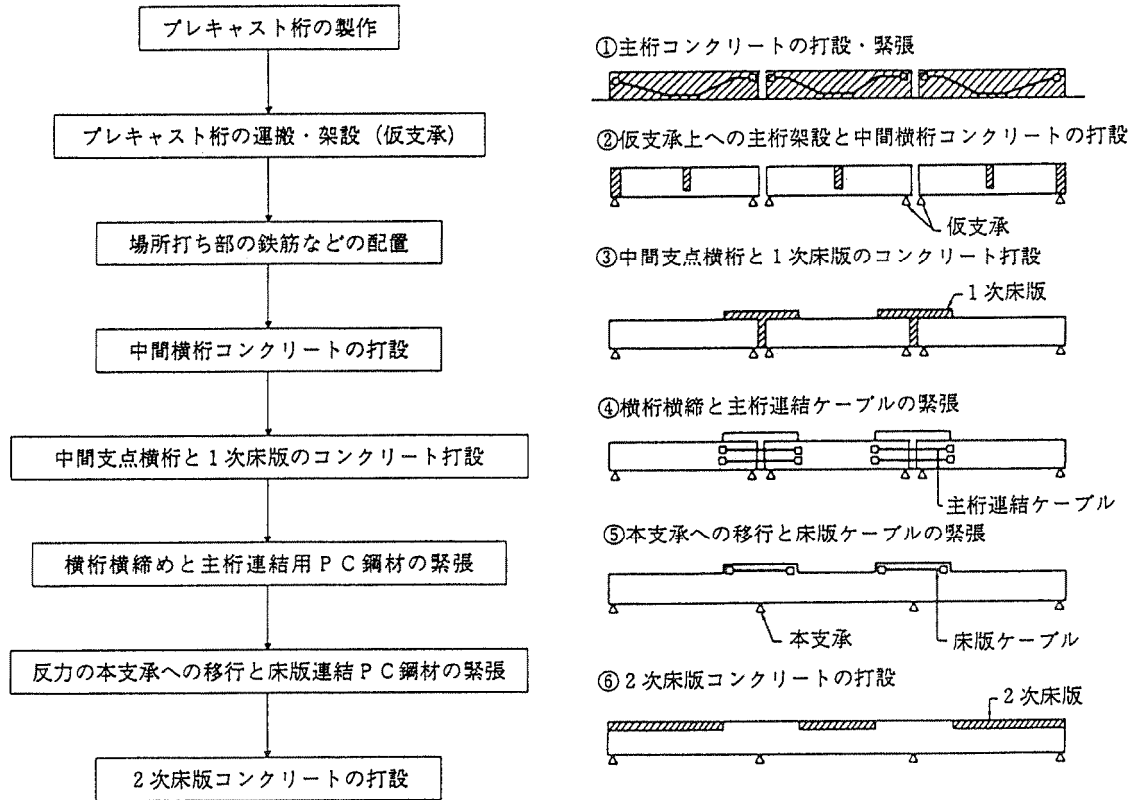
PC 連結方式の合成桁の施工手順の例
